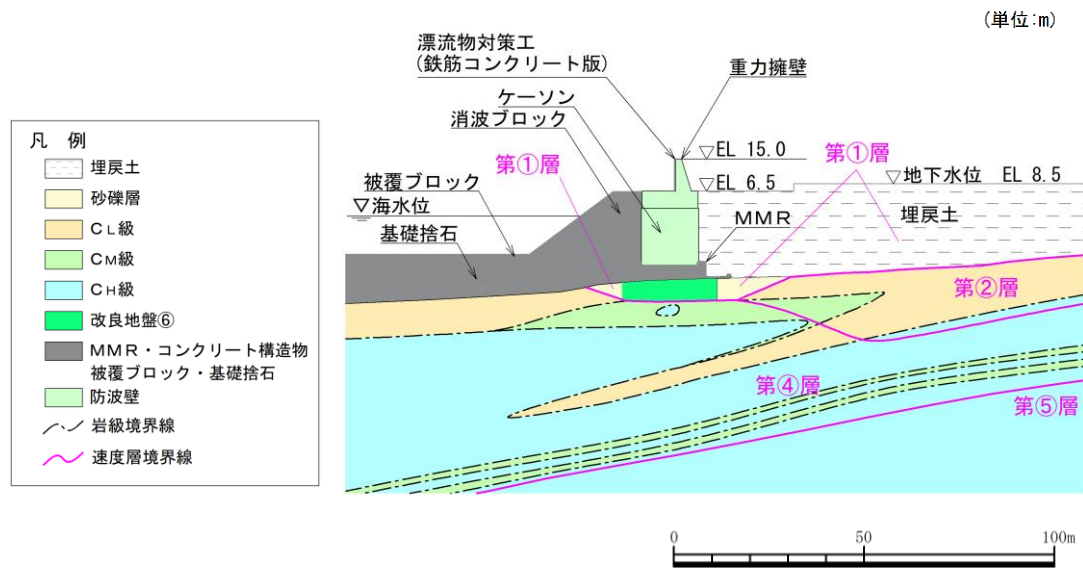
防波壁（波返重力擁壁）の横断面図（②-②断面）
